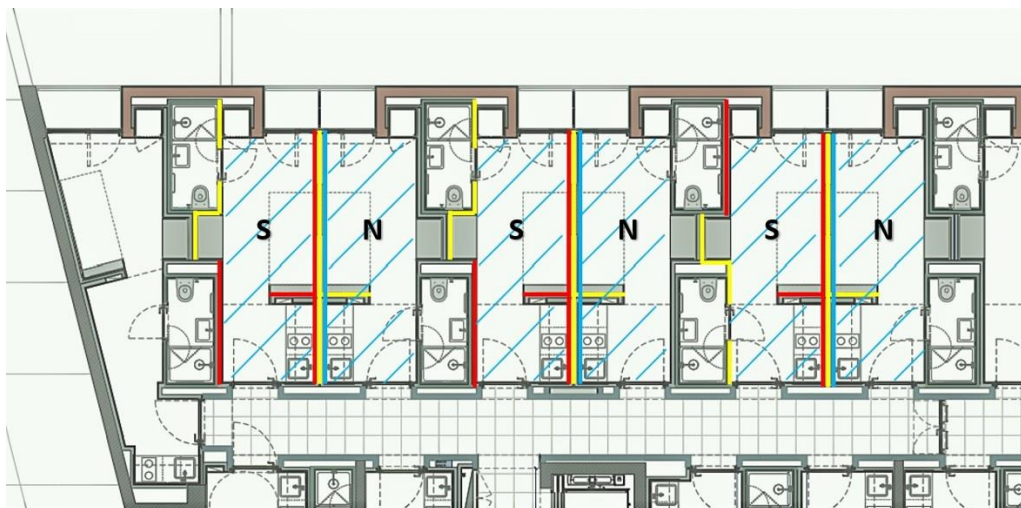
Áreas de intervenção Fase 3 - Zona azul (Adaptado de: Planta Piso Tipo – Anexo V)
